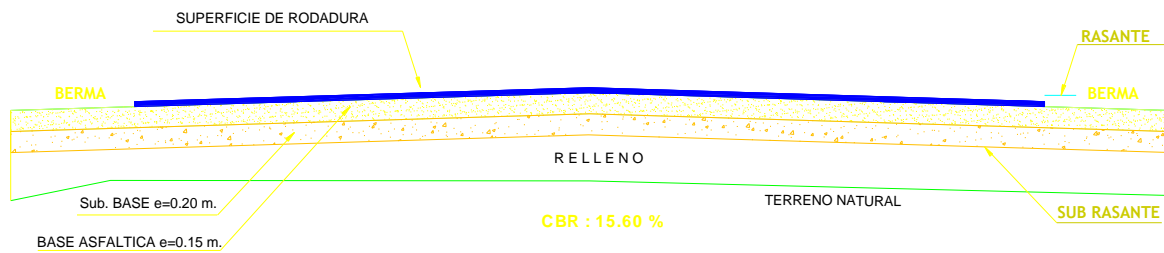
Estructura de Pavimento Alternativo N°2 (ver anexo F-3).
